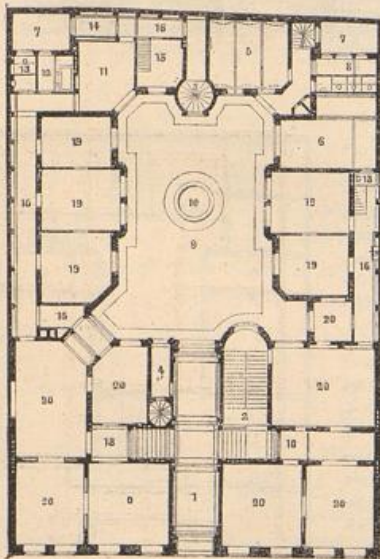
Grundriss vom Erdgeschoss.
